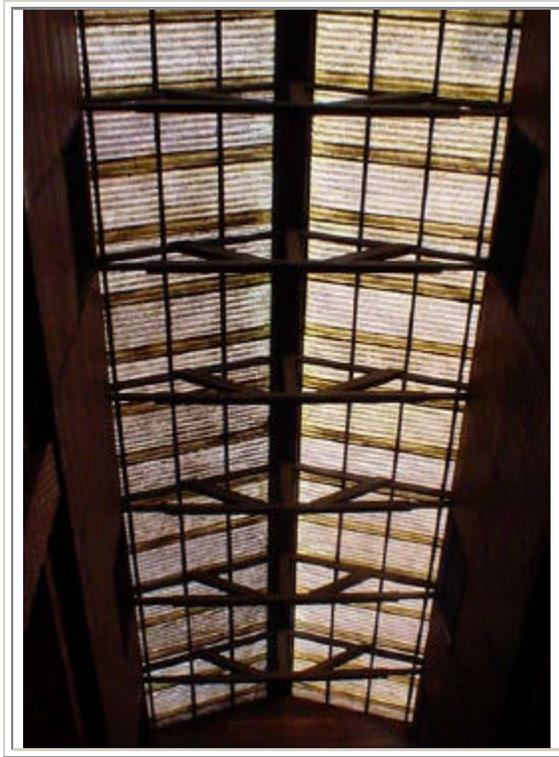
Cubierta con placas de fibra de vidrio.
